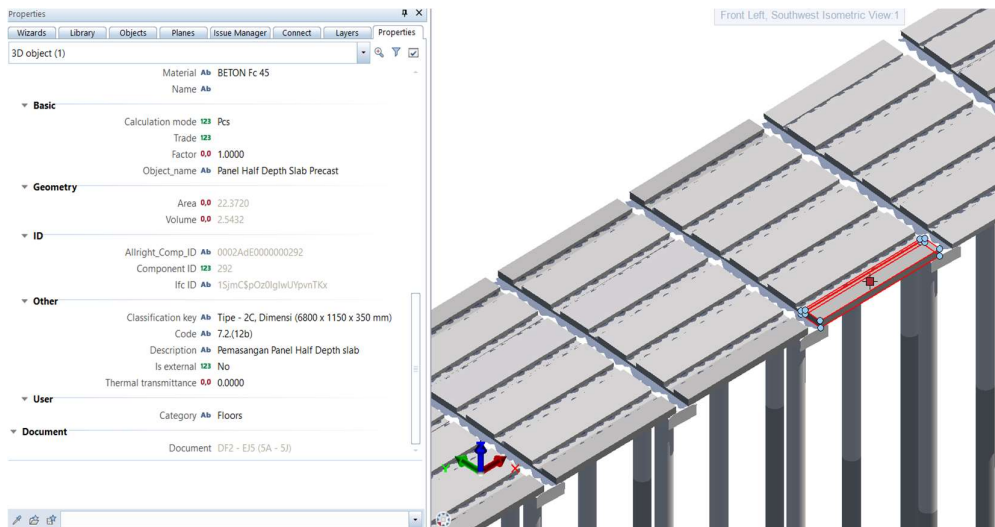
Quantity Take Off Beton Half Slab Precast Tipe 2A
